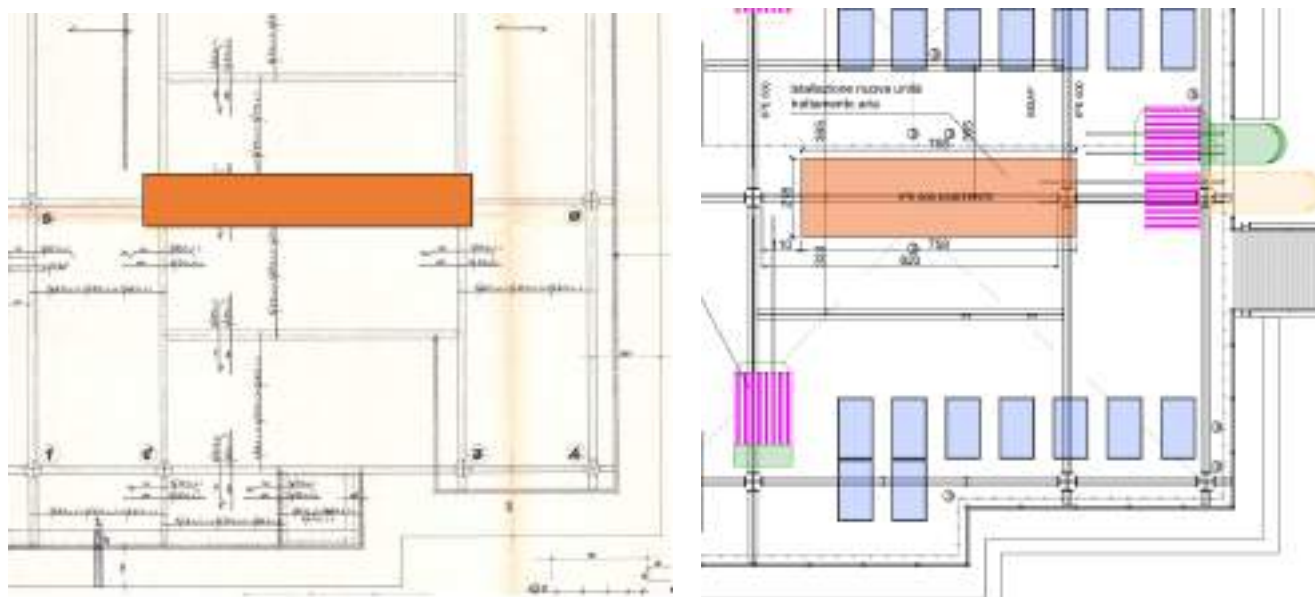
Posizione degli impianti della CTA sul tetto sovrapposta allo schema strutturale dell'edificio.
